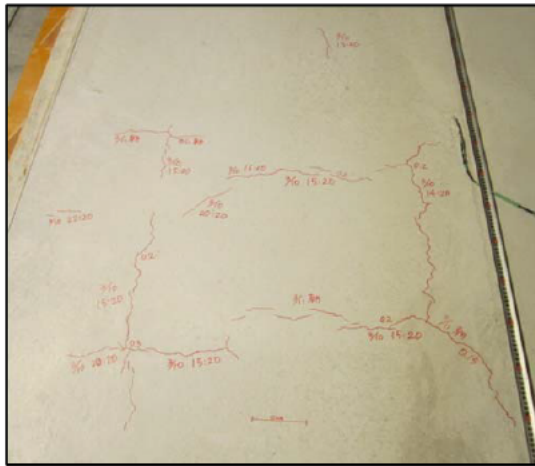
プラスチック収縮ひび割れの発生状況（実験）
